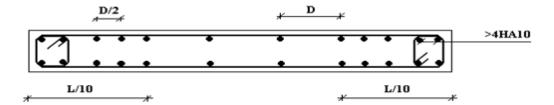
Disposition des Armatures verticales dans les voiles.
